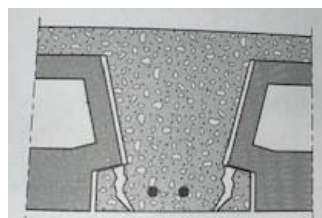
Cisaillement de talon de poutrelles de plancher à entrevous et nervures.[13]
